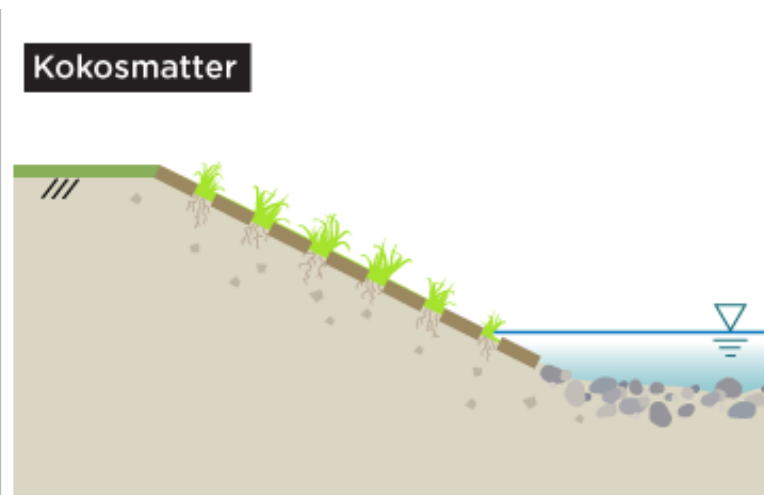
Vier planta i kokosmatter på ny erosjonssikring, (NVE, 2023).
